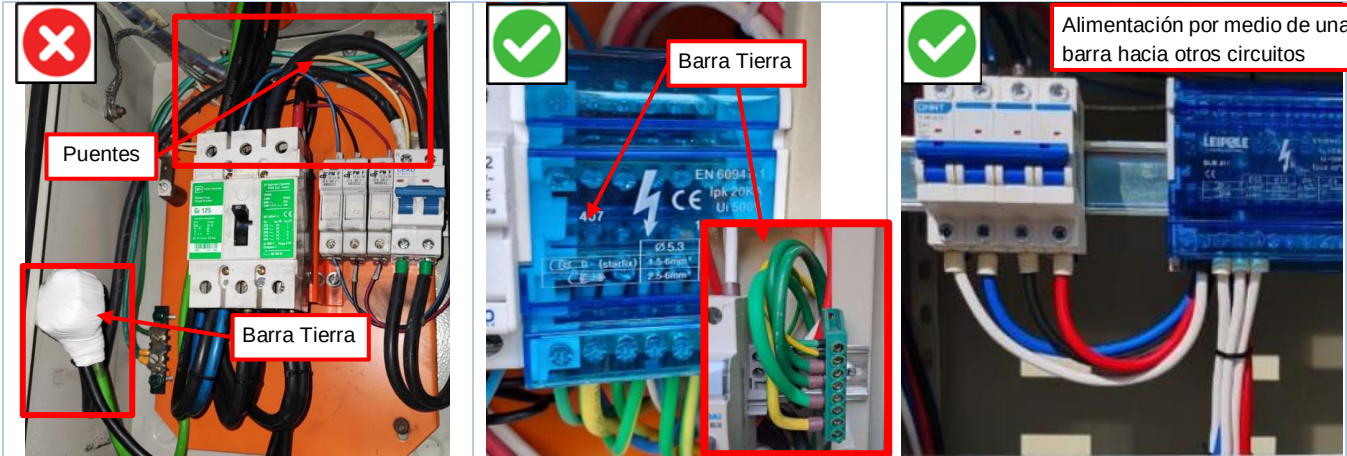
Buenas y malas prácticas en unión de barras y barras de distribución.
